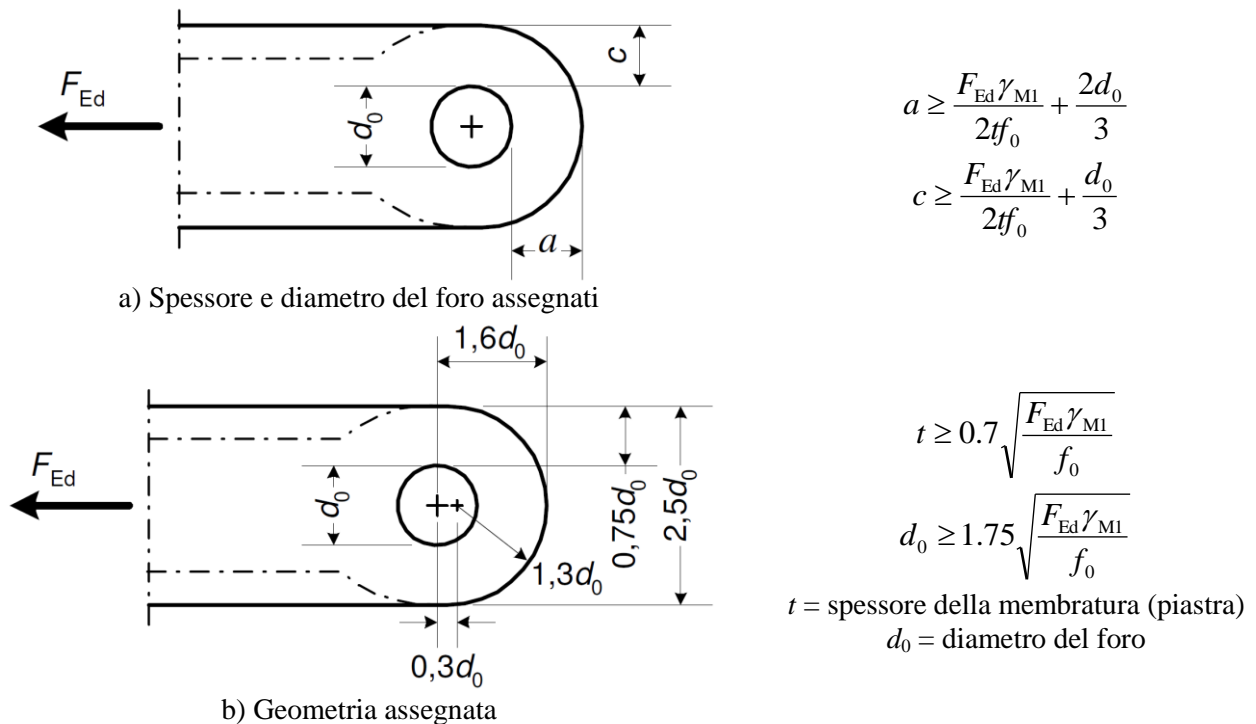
Requisiti geometrici delle piastre nelle unioni con perno.
